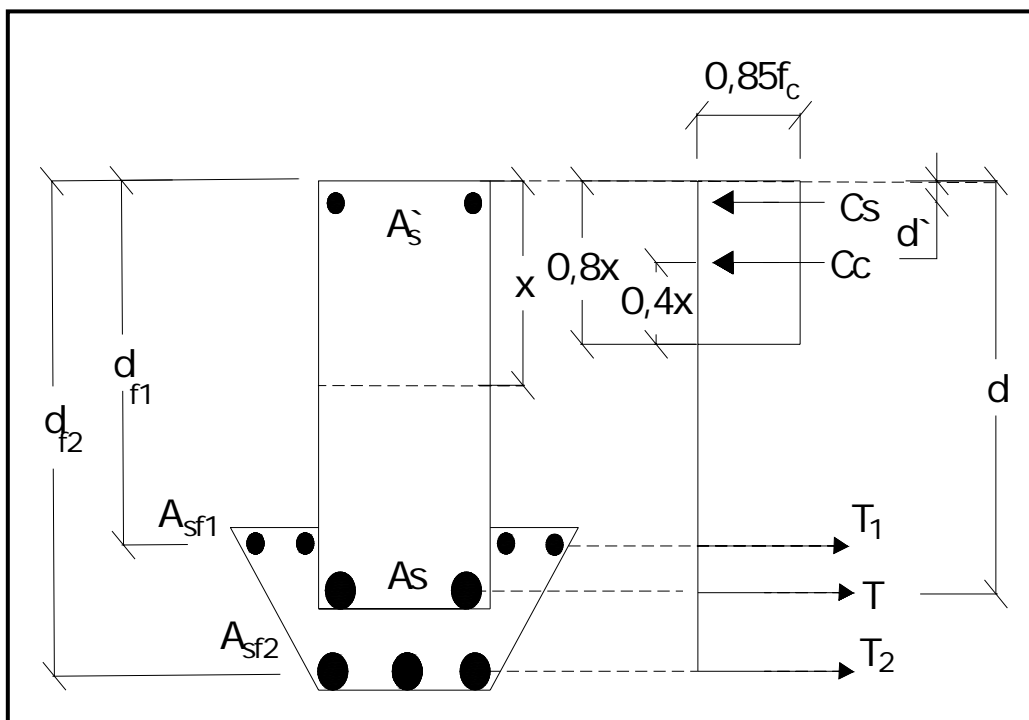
Diagrama retangular simplificado de tensões na seção da viga reforçada à flexão por encamisamento parcial.
